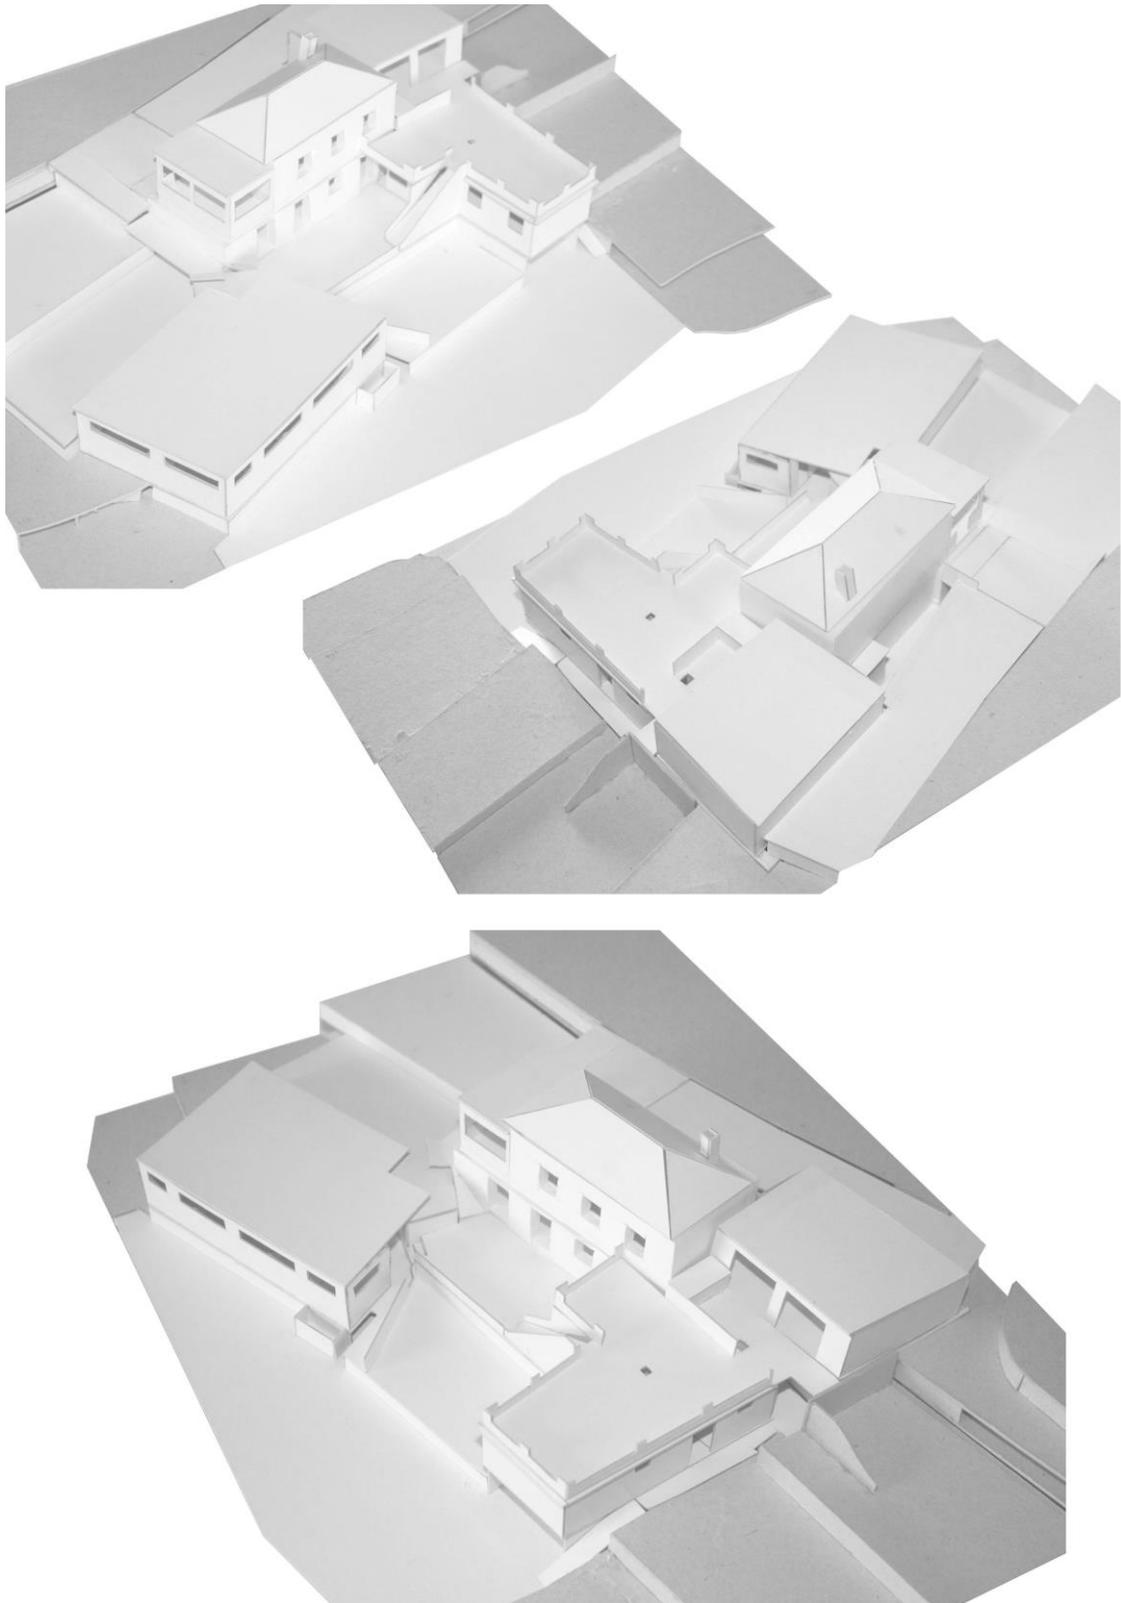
Conjunto de fotografias da maquete da habitação fruto do levantamento arquitetónico.
